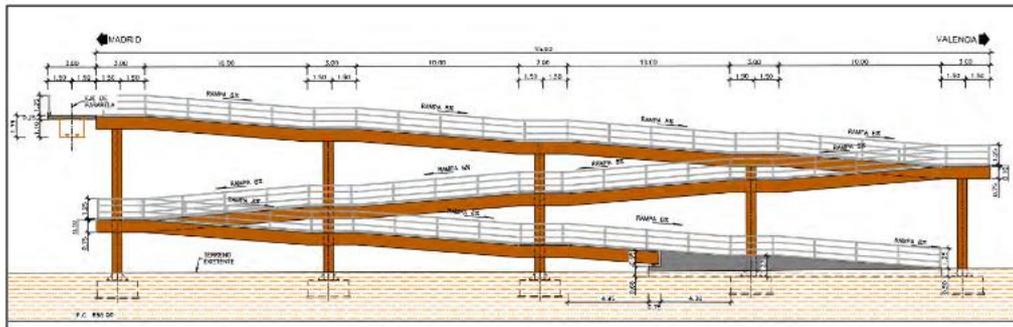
Alzado longitudinal rampa de acceso sentido Valencia. PAS 9+090
